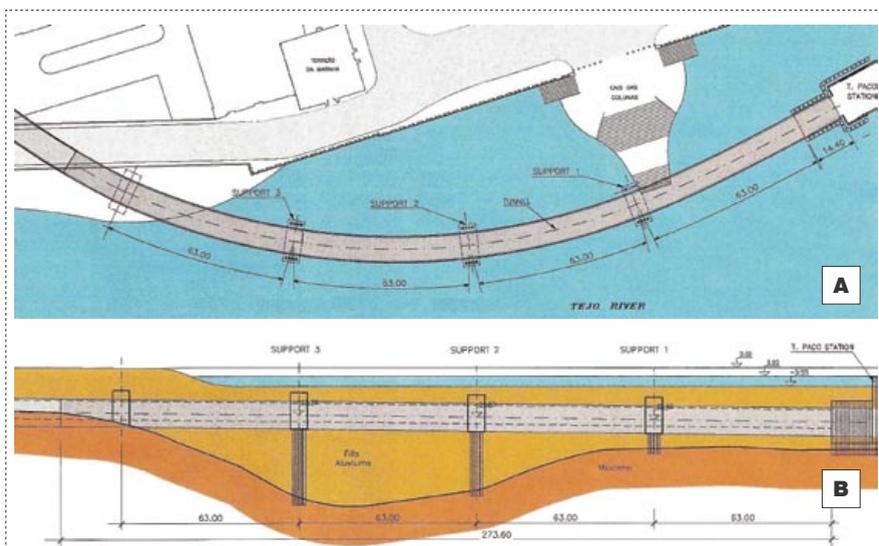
Planta e alçado lateral do túnel. a) Planta b) Alçado lateral
